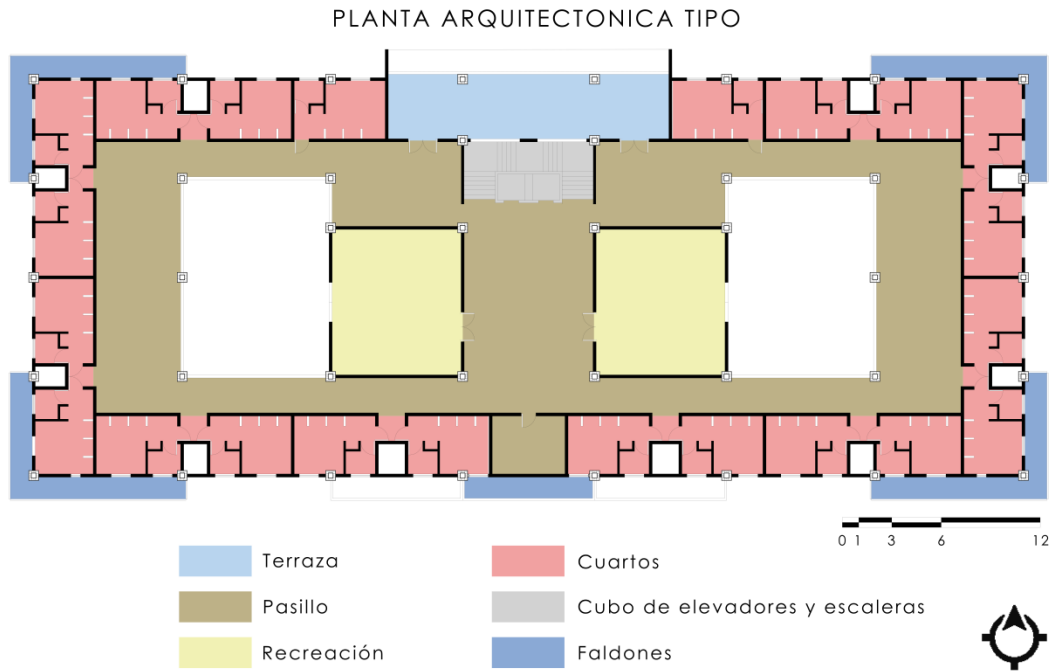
Zonificación de áreas generales planta tipo. Fuente: propia, edición: González, 2018.
